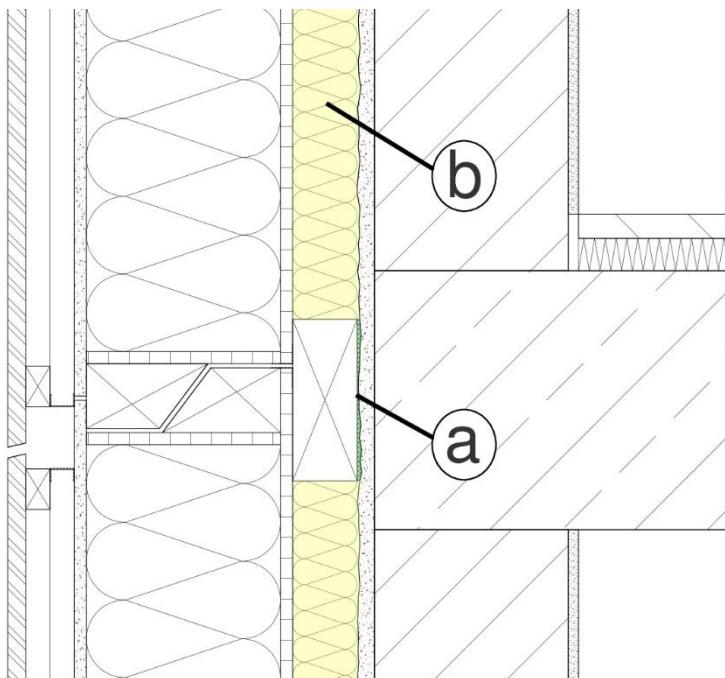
Ausgleich der vorhandenen Toleranzen am Bestandsgebäude (a) Die Montagebalken werden durch Abstandhalter ausgerichtet (b) Der verbleibende Hohlraum wird vor Anbringen der Elemente mit Mineralwolle gefüllt
